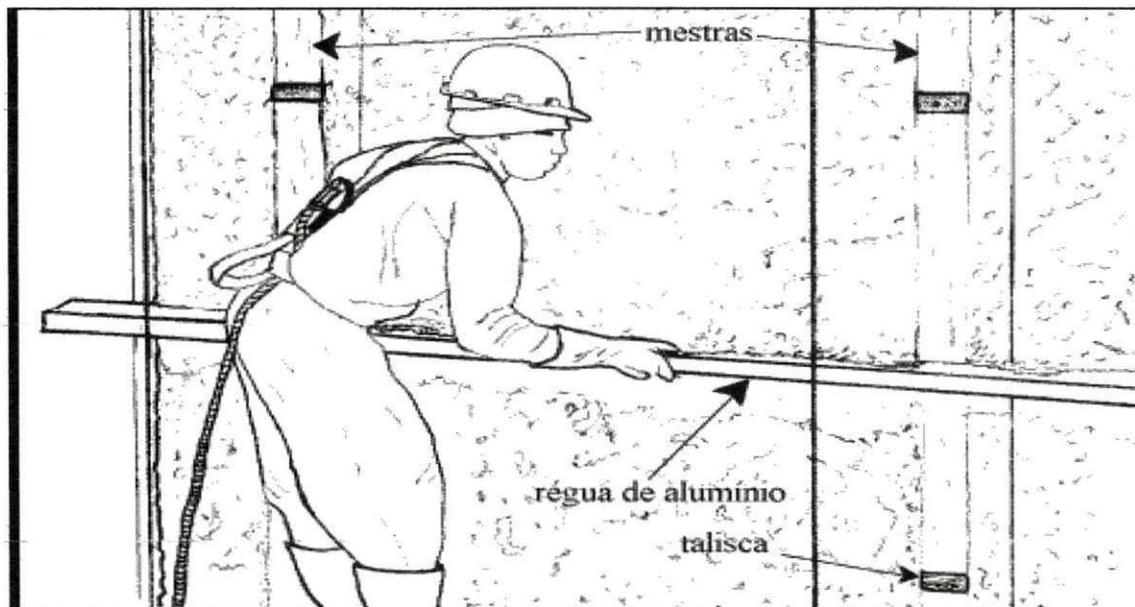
Sarrafeamento do Emboço Paulista/Reboco.
